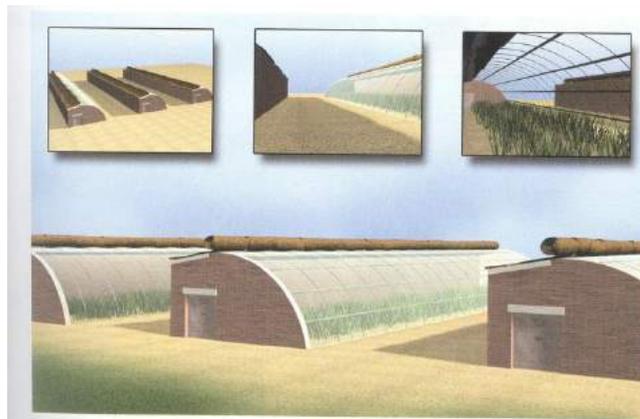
Dispositivos de aislamiento en invernaderos con pantallas térmicas móviles
